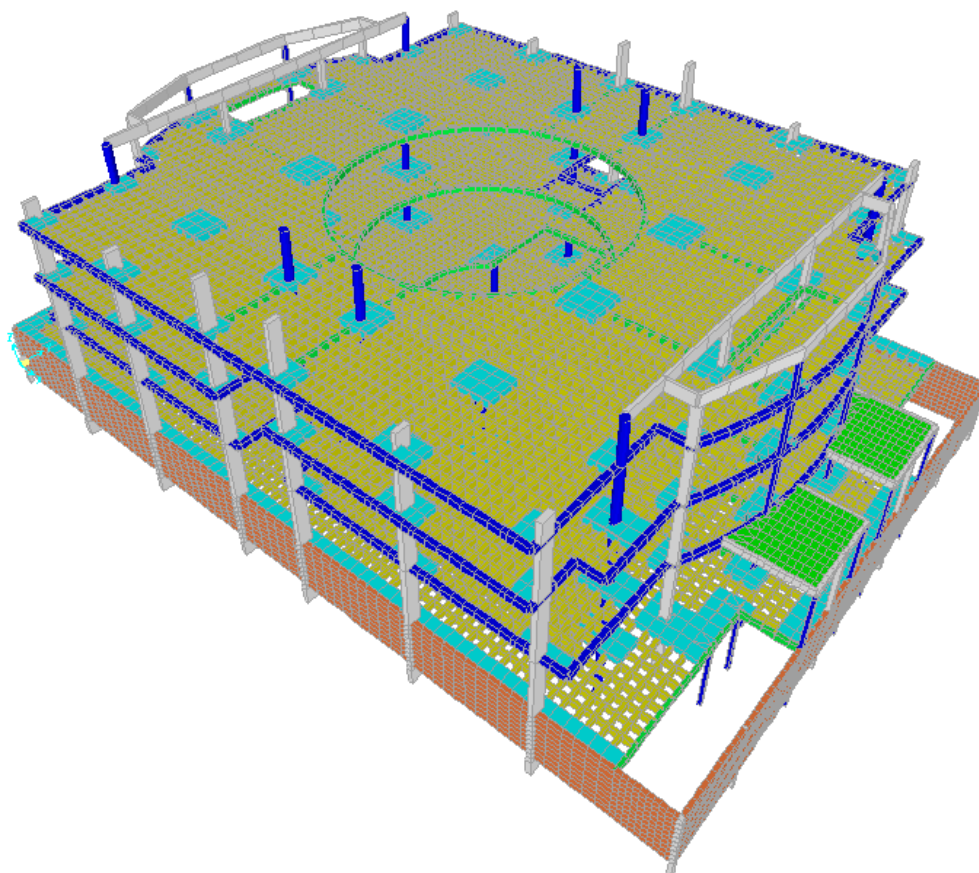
Modelado estructura sin vigas peraltadas mediante el método del emparrillado espacial de vigas
